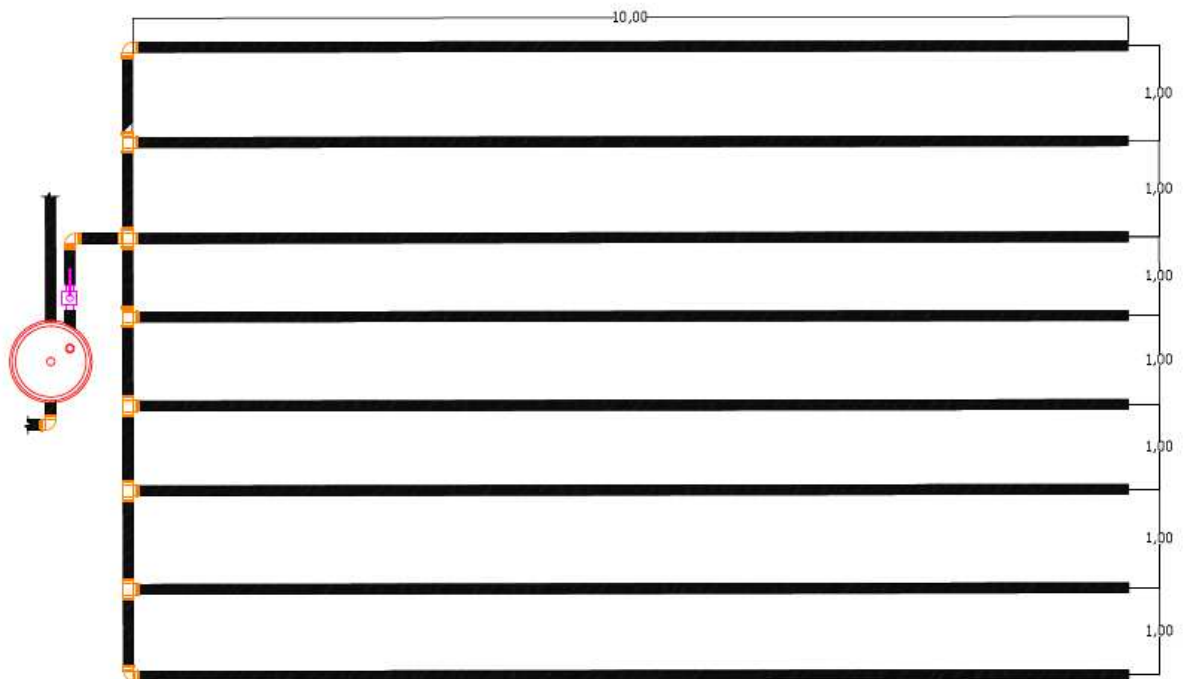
Planta de detalhe do sistema de distribuição do biofertilizante (O autor, 2019).
